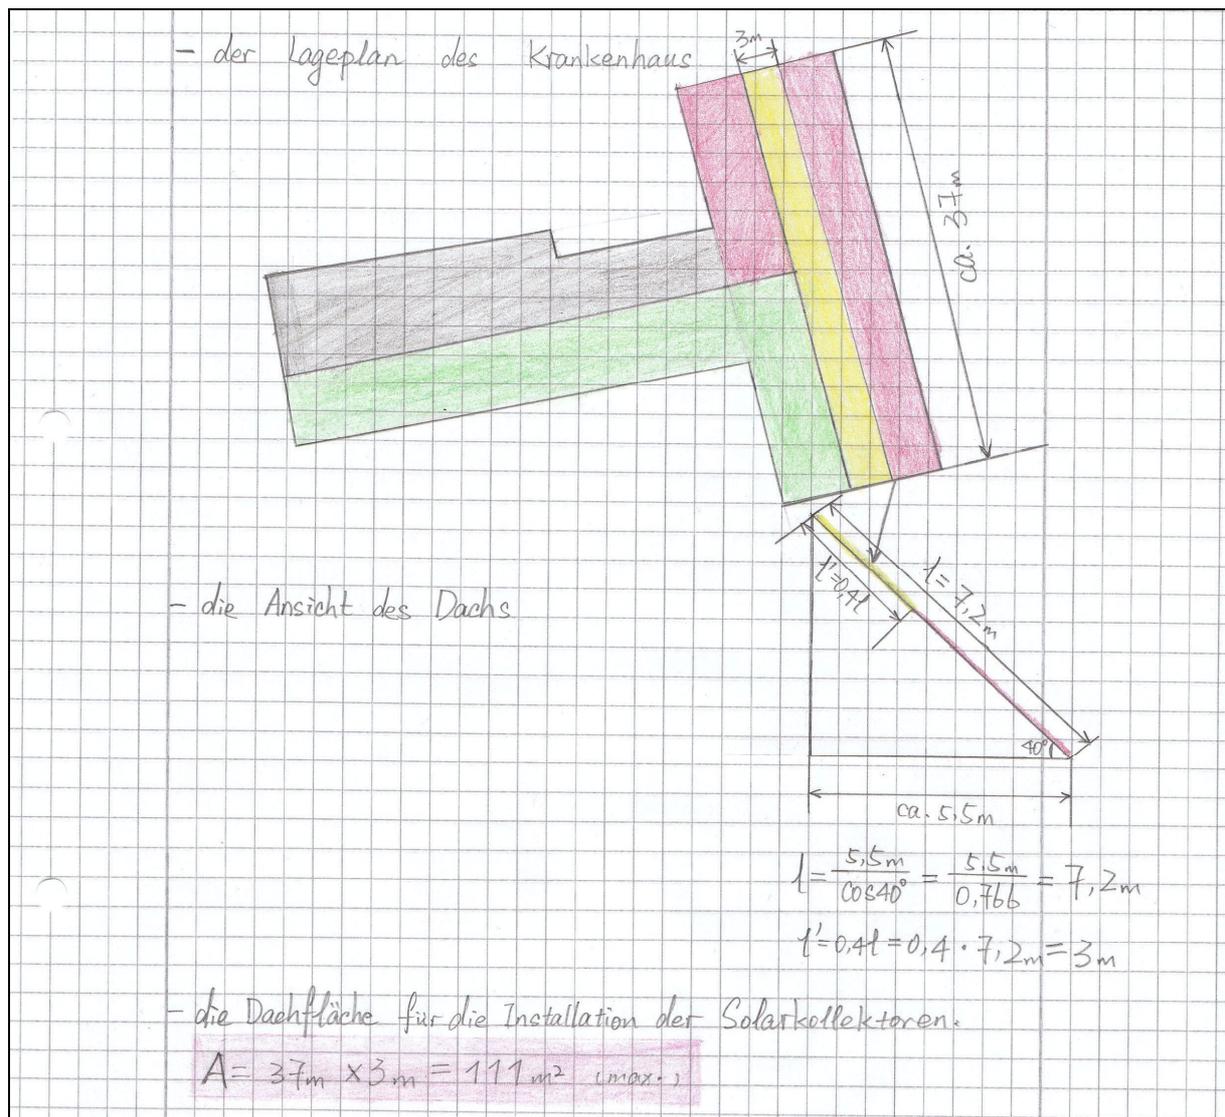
Vorhandene Dachflächen des Krankenhauses.
